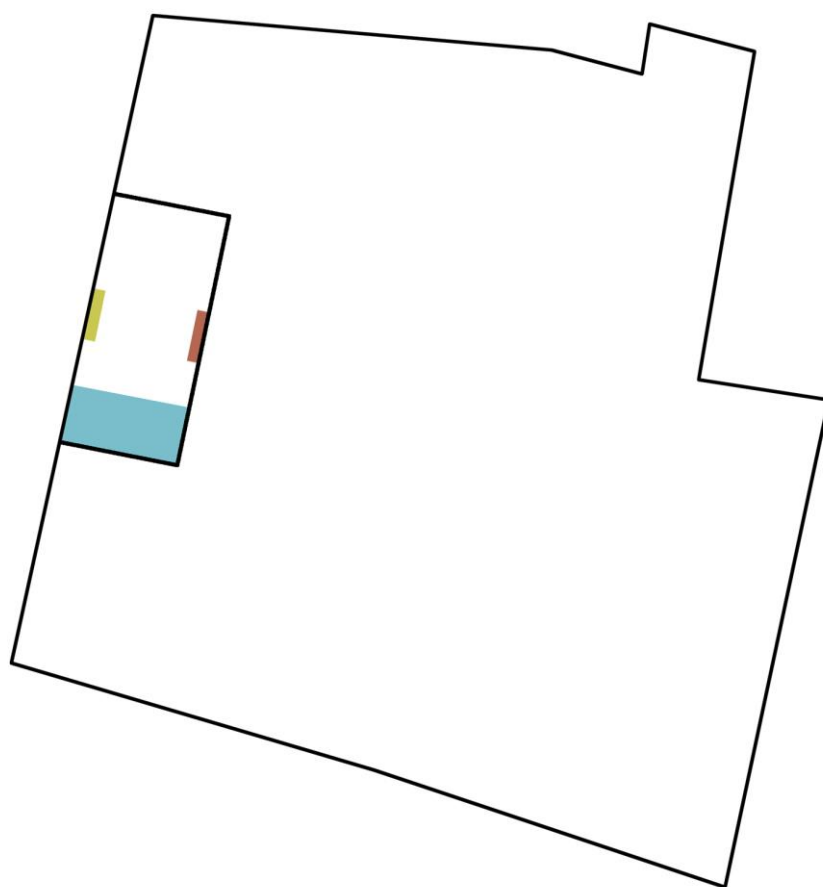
Planta del monasterio de Ntra. Sra. de los Ángeles.
